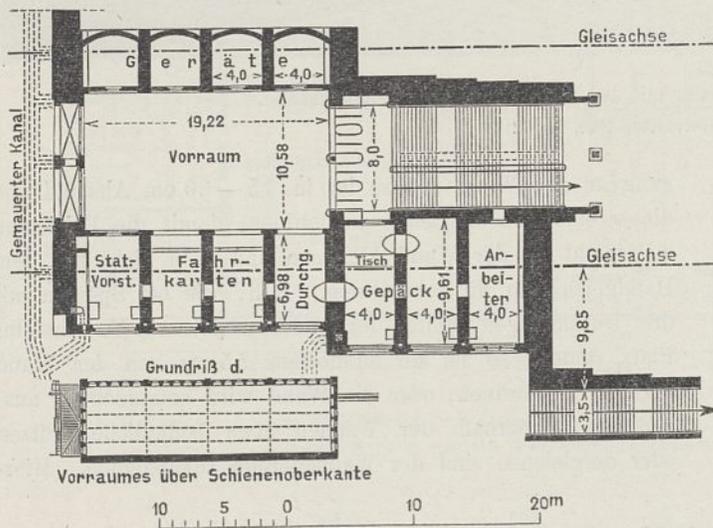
Empfangsgebäude auf Bahnhof Friedrichshagen.
